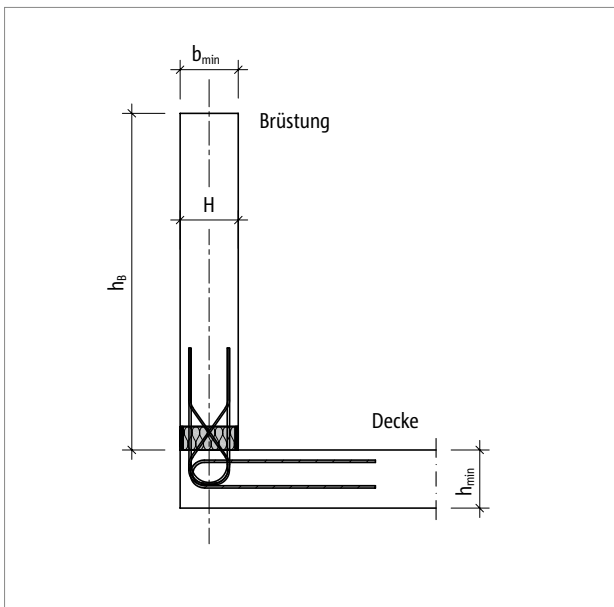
Schöck Isokorb® T Typ AP: Statisches System Brüstungshöhe  $h_B$ ; Isokorb® Höhe H
